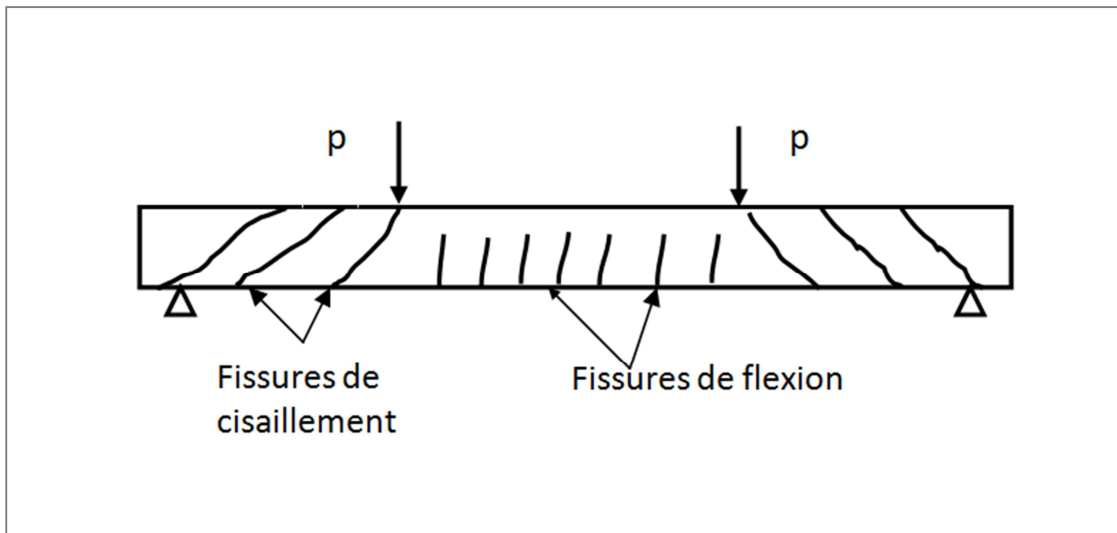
Schématisation d'une poutre fissurée soumise à deux charges concentriques p [23].
